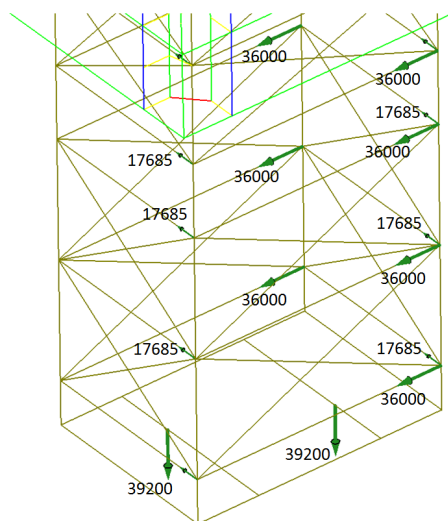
Detalle de las cargas consideradas en los canastos sumergidos del Puente de Operaciones.
